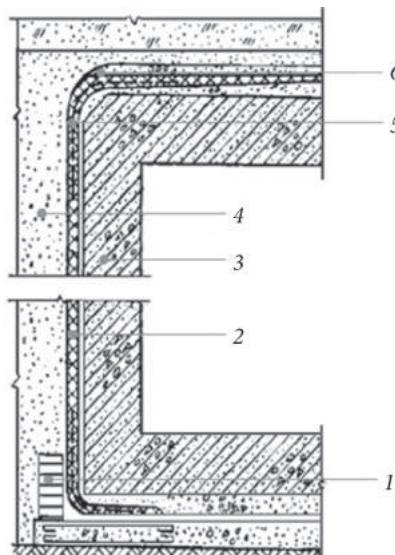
Схема устройства штукатурной гидроизоляции: 1 — защитная стенка; 2 — штукатурная гидроизоляция; 3 — изолируемая конструкция; 4 — дренирующий слой обсыпки; 5 — армирование гидроизоляции; 6 — защитная конструкция
